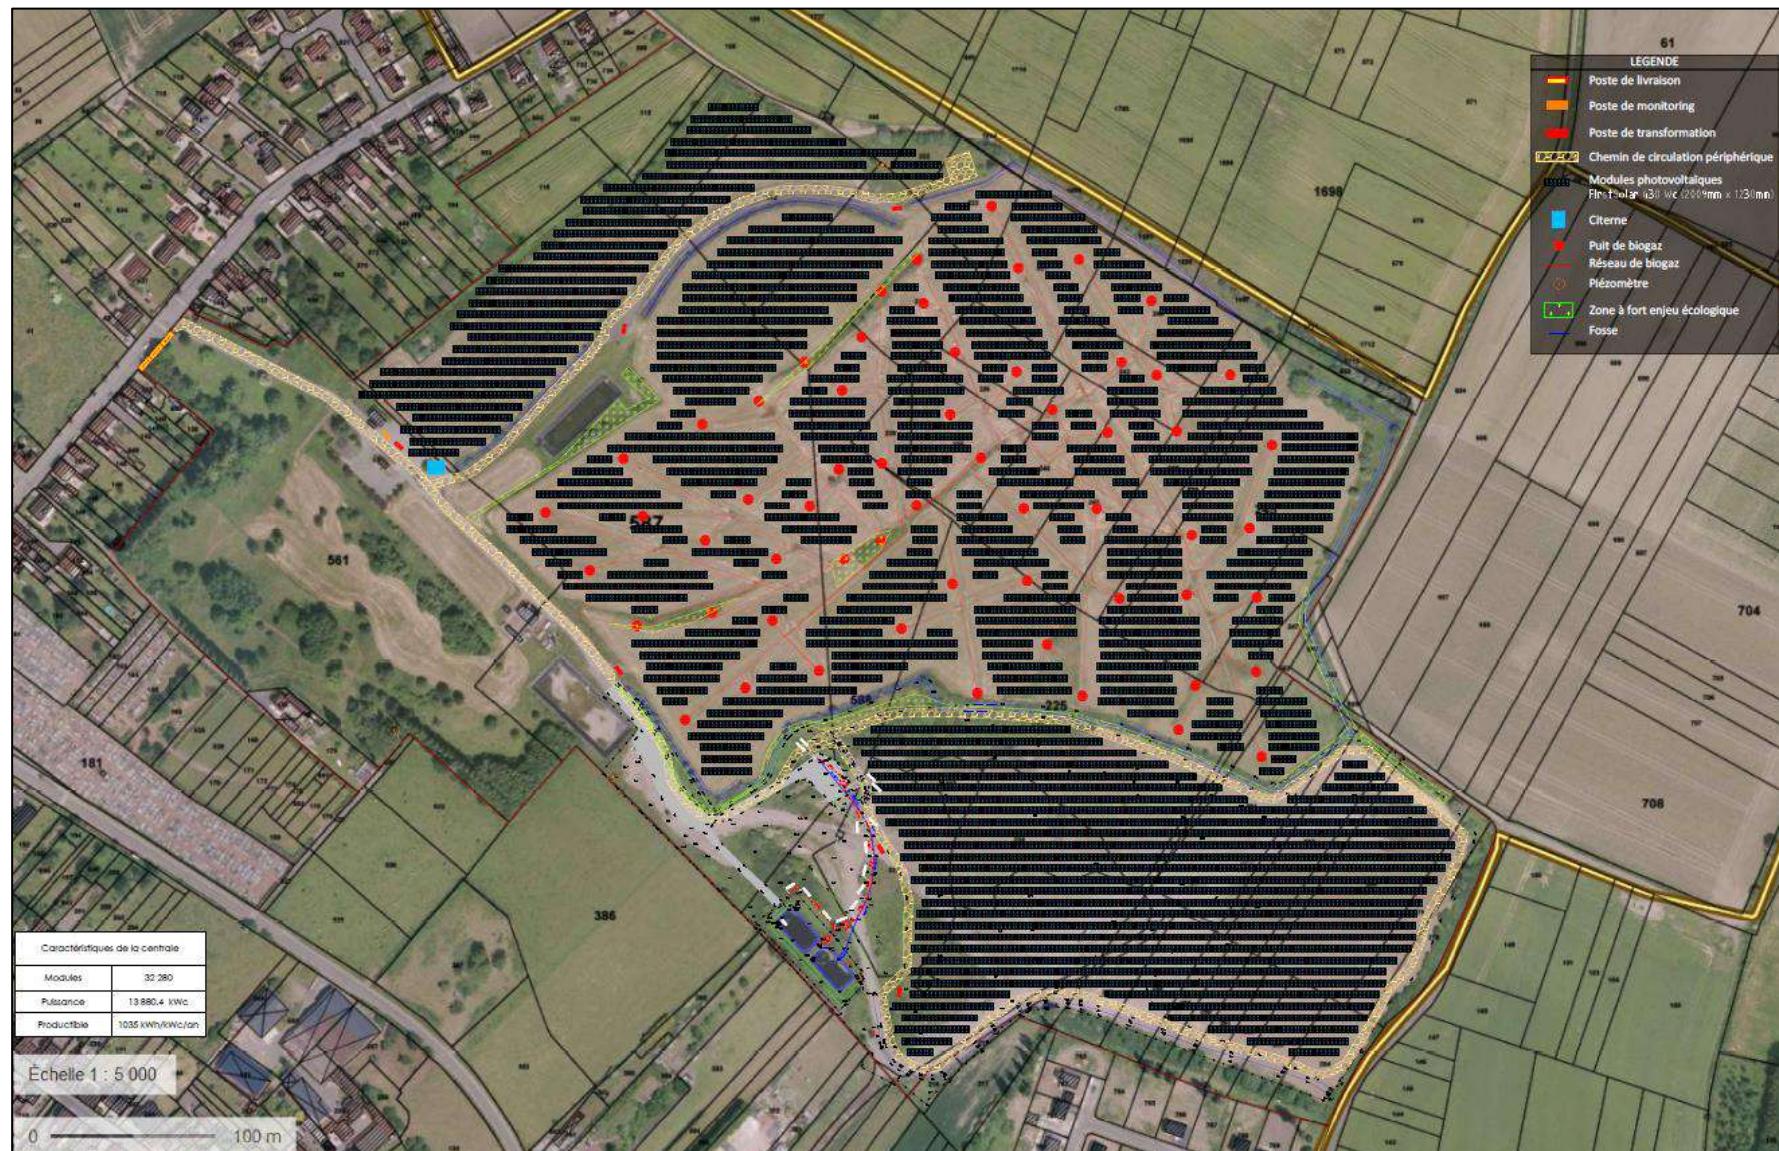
Plan d'implantation générale du projet de centrale solaire sur le site de Leforest (source : GDS)
